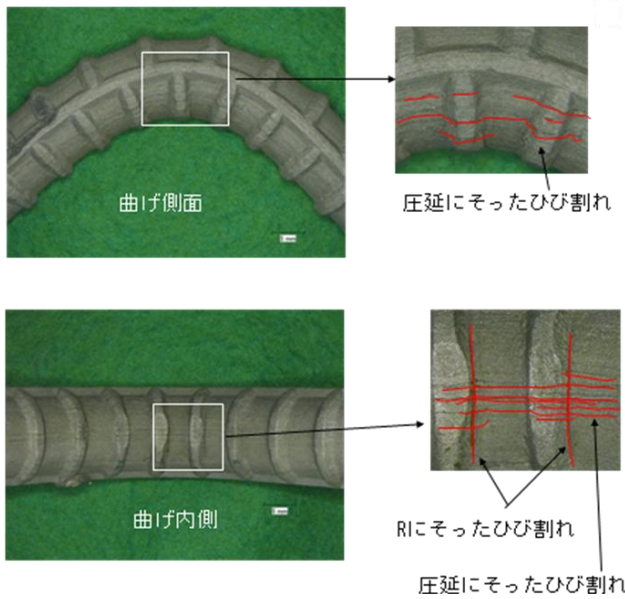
鉄筋の曲げ加工部のひび割れ発生状況
